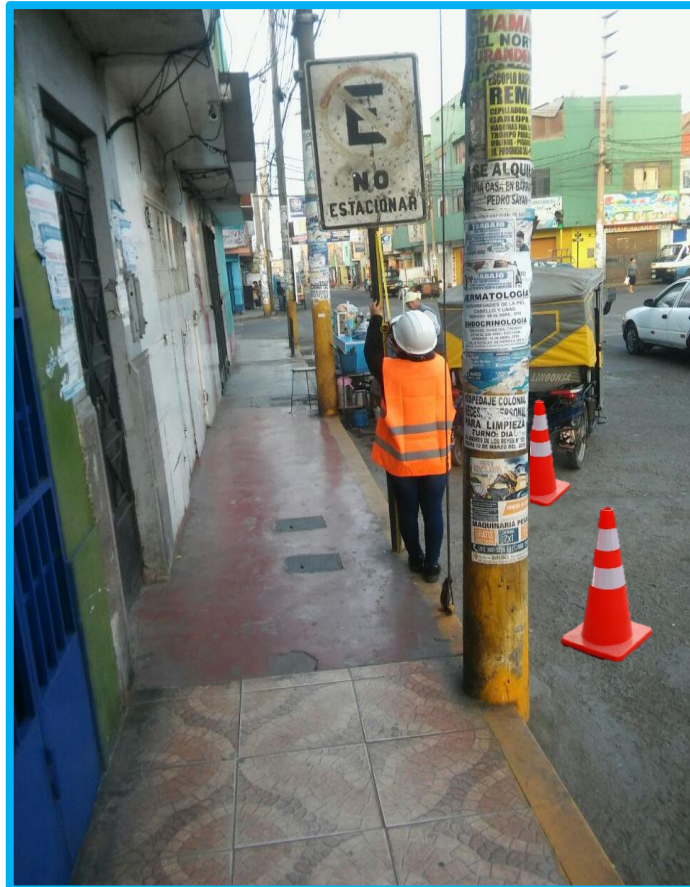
Medición de las marcas en el pavimento (ancho) para corroborar si cuentan con las medidas propuestas en el de MDCTACC.
